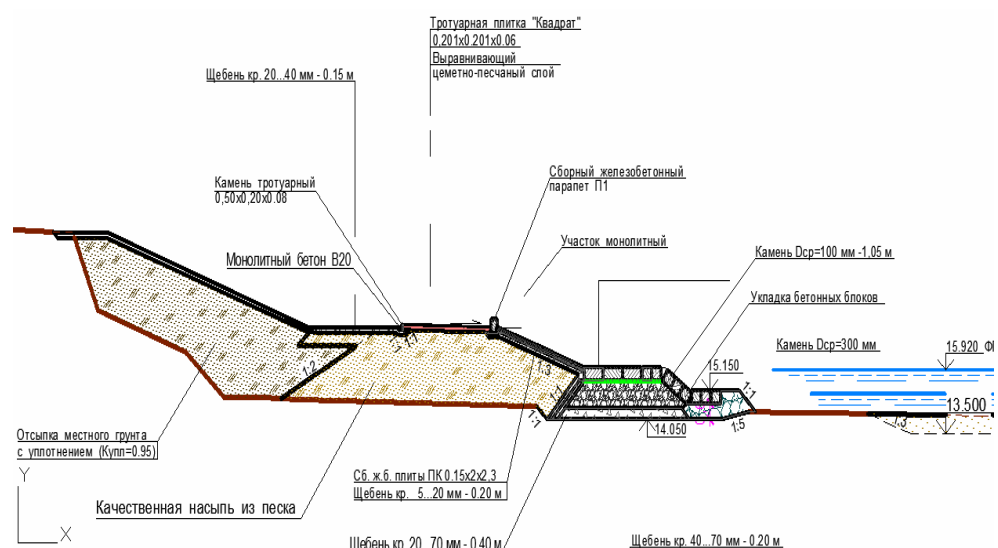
Схема конструкции берегоукрепления набережной в г. Николаевске
